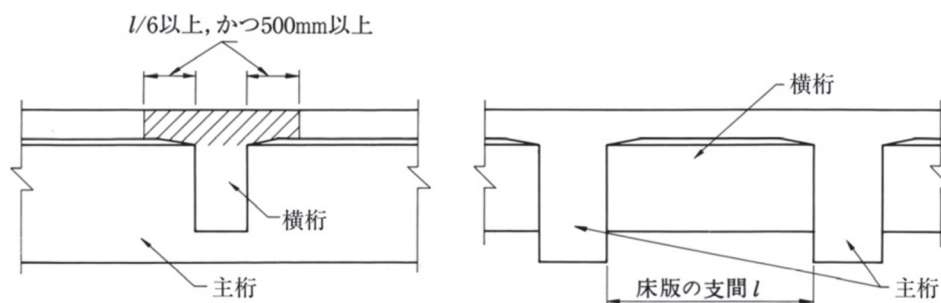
横桁上の床版の上側鉄筋等の配置範囲
